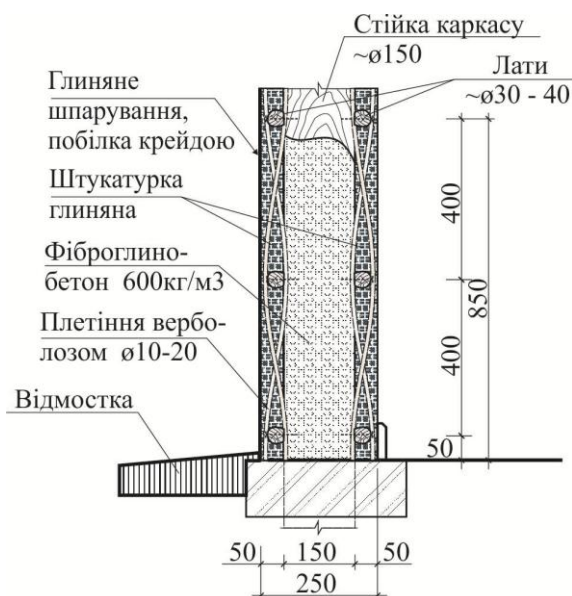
Конструкція стіни господарської будівлі з фіброглінобетону
